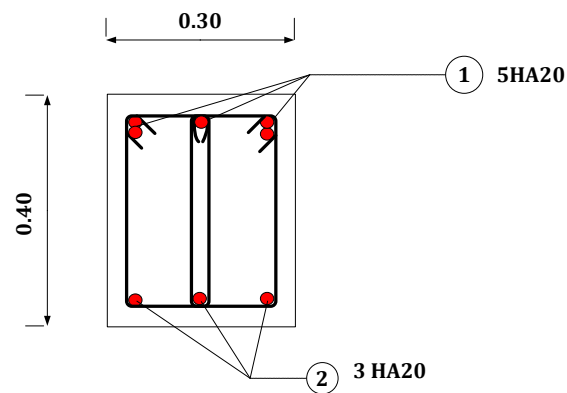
Ferrailage de la poutre 30×40 cm².
